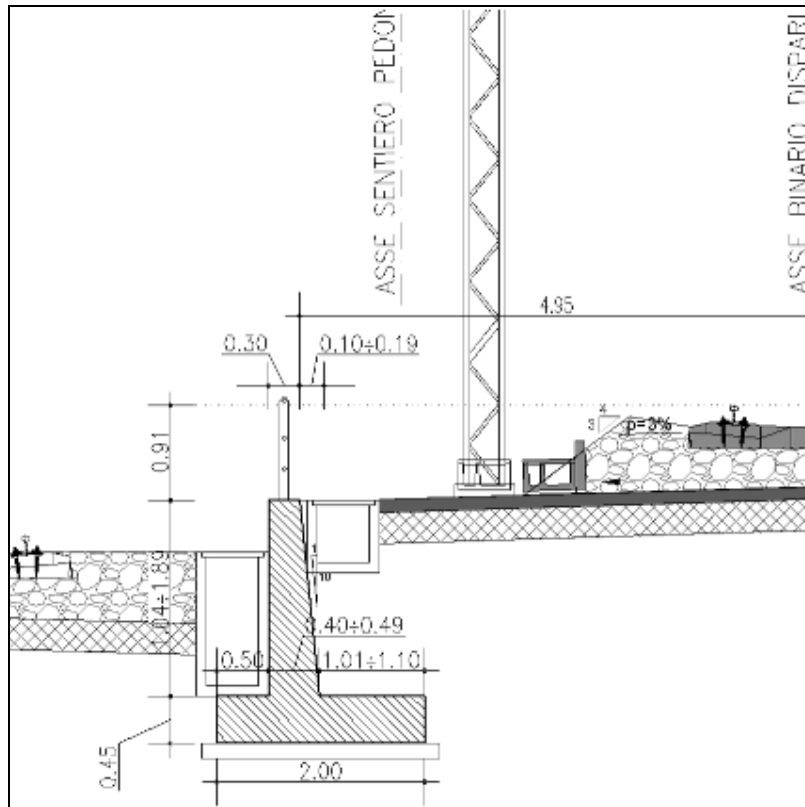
sezione tipo muro tipo 2 conci 4+8,
